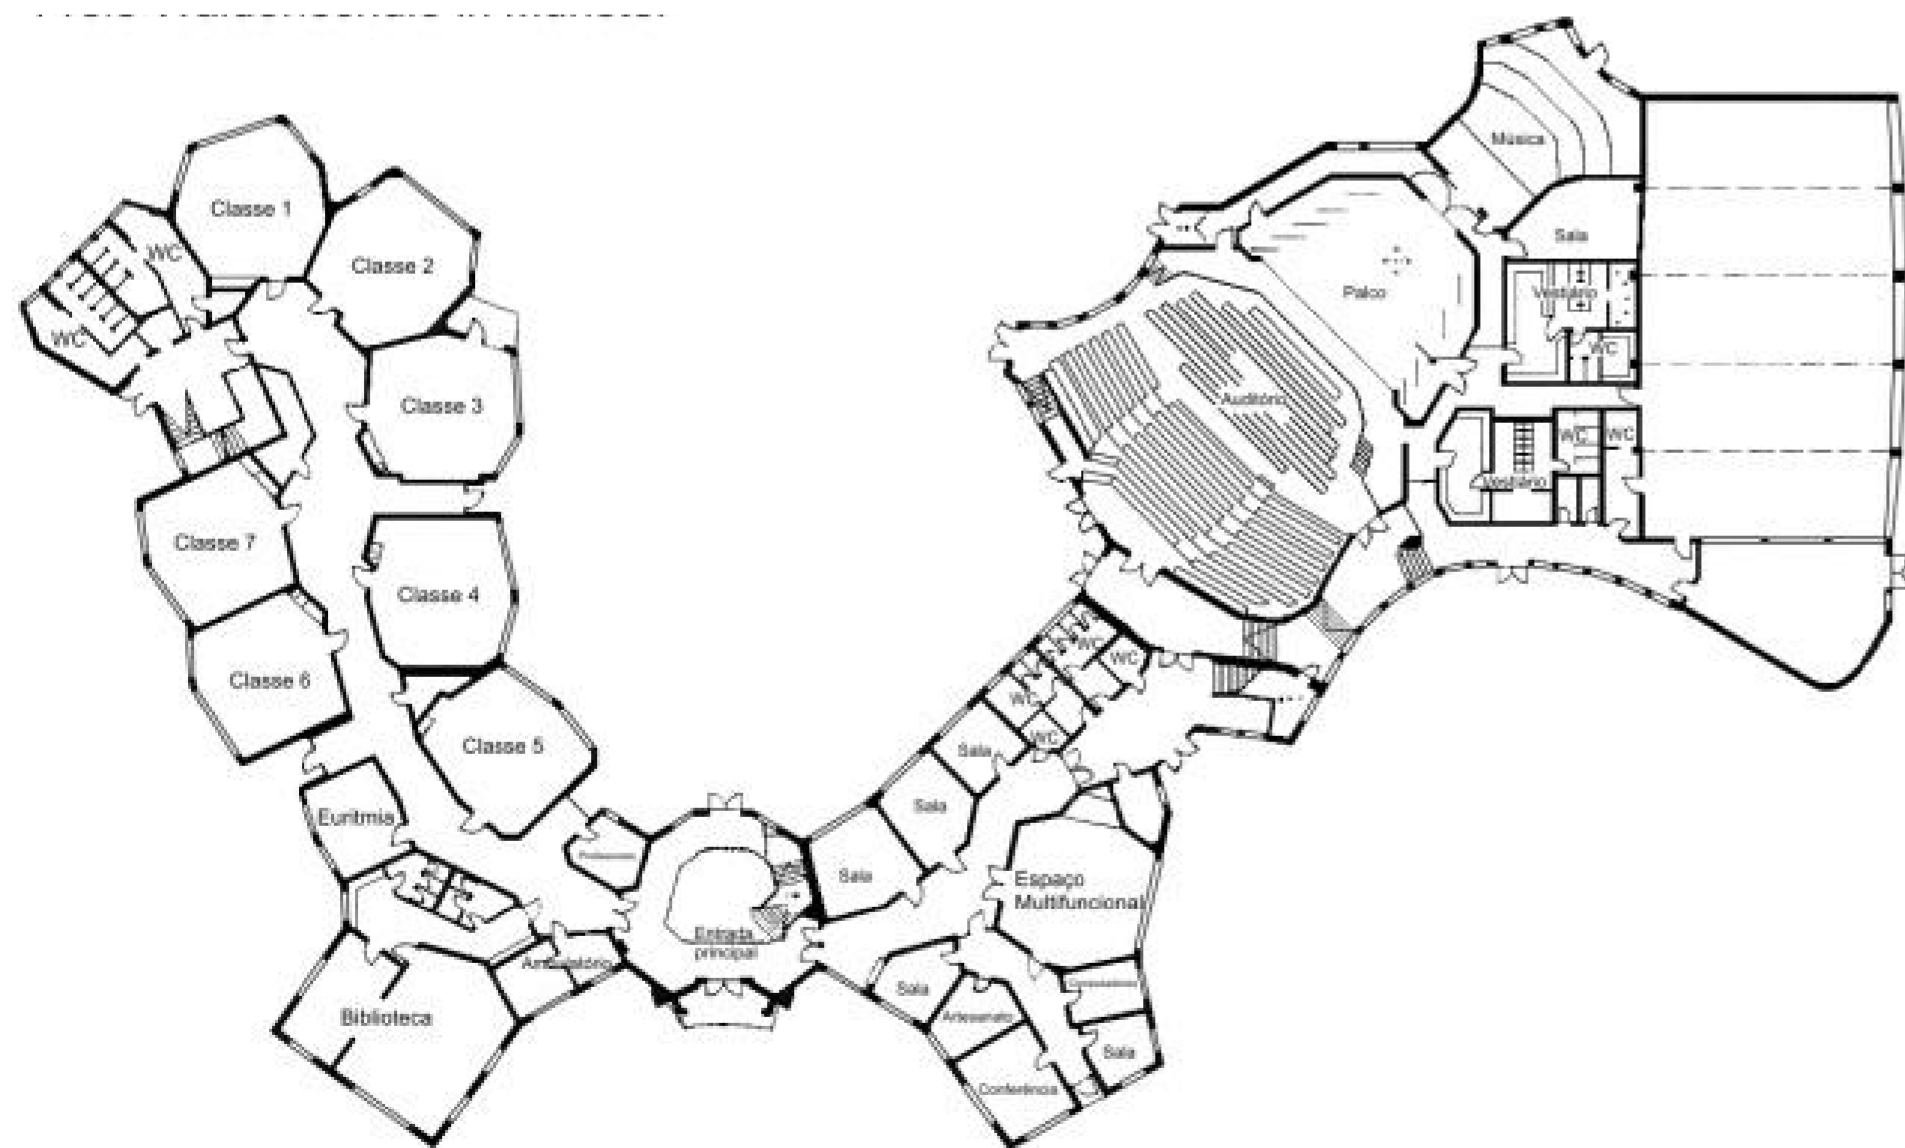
Planta baixa da escola Waldorf Freie em Münster.
